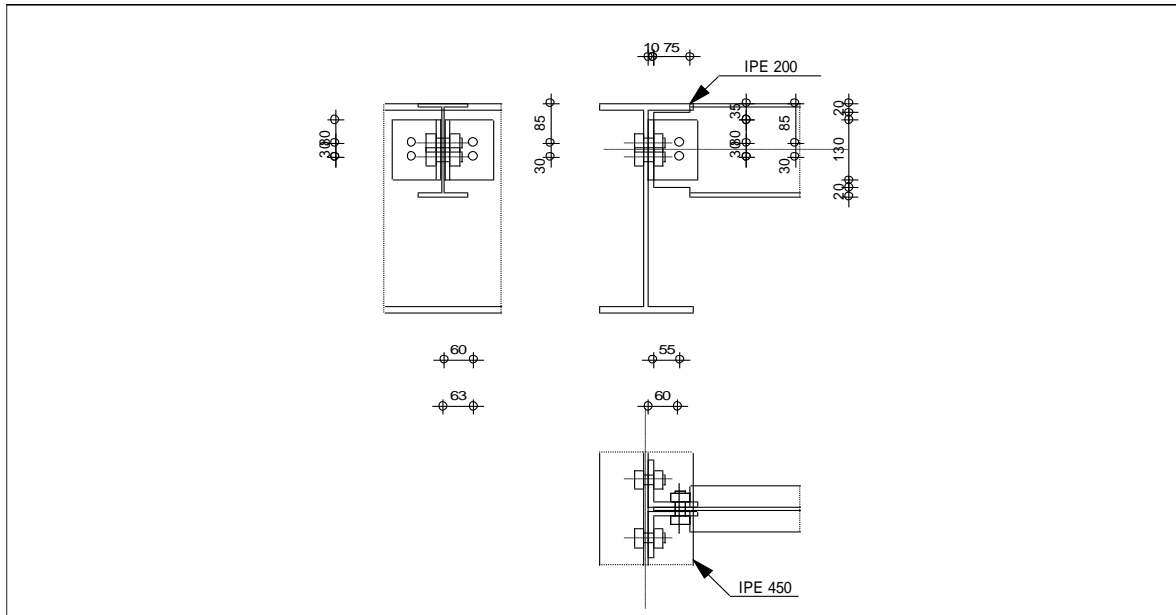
Disposition constructif de l'assemblage poutre – solive.
